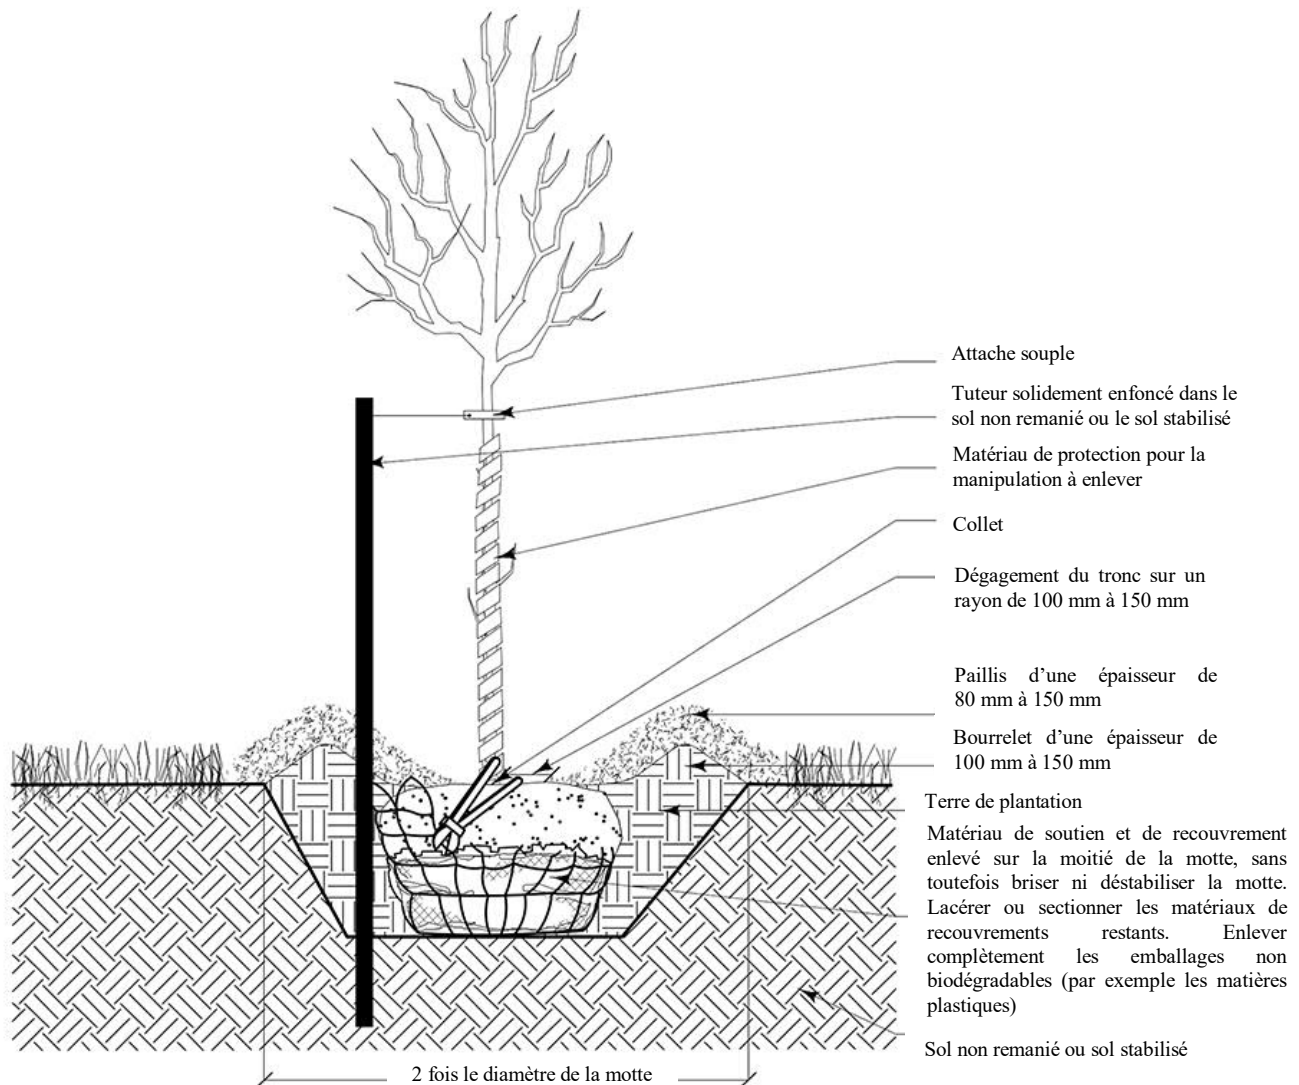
EXEMPLE DE PLANTATION D'UN FEUILLU STABILISÉ PAR UN TUTEUR (ENLÈVEMENT PARTIEL DU MATÉRIAU DE SOUTIEN ET DE RECOUVREMENT)
